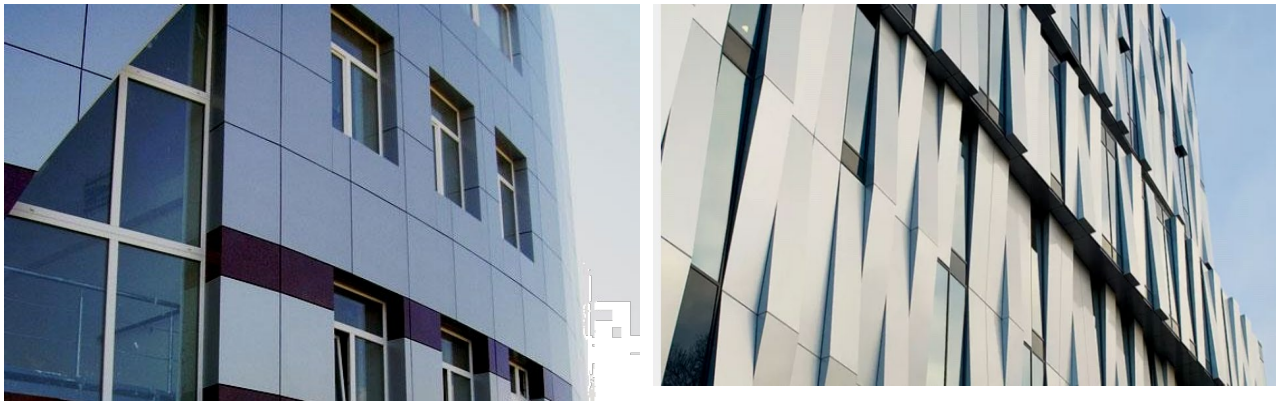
Варіанти вентильованого фасаду із застосуванням фасадних касет з алюмінію
